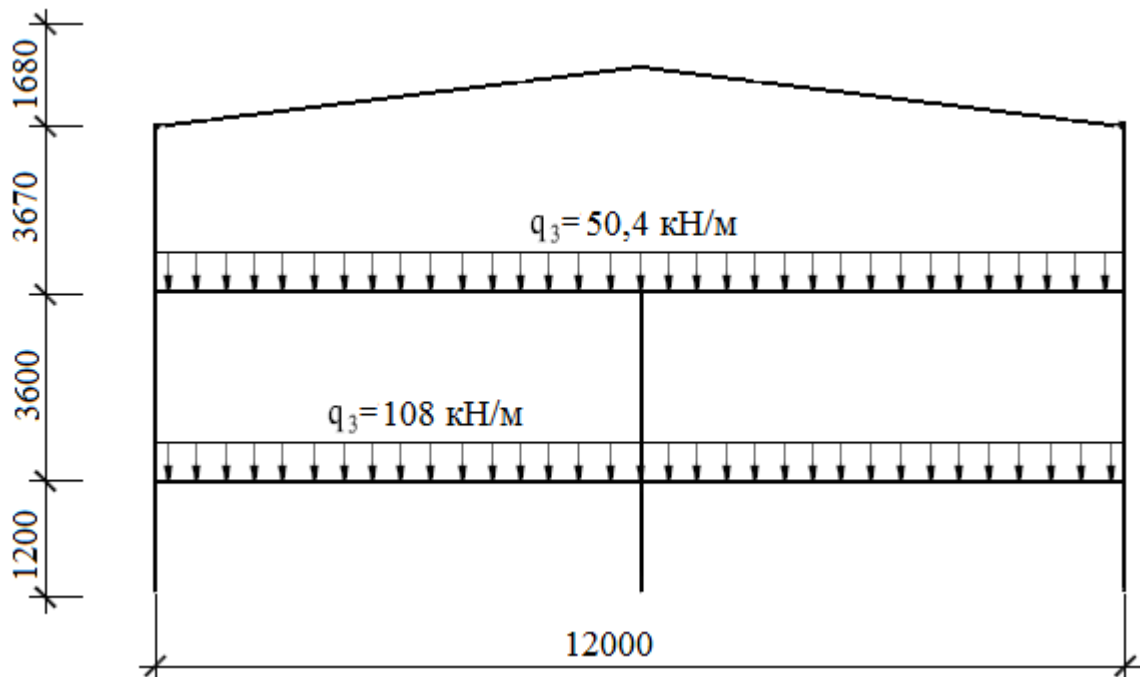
Кратковременная нагрузка на перекрытия
